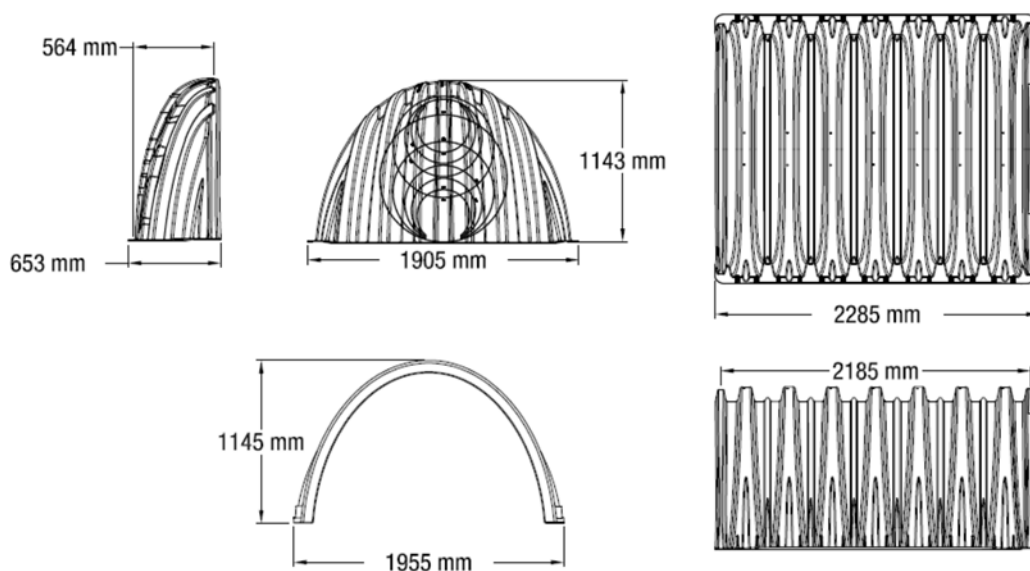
Dimensions de la chambre STORMTECH MC3500 (tolérance : 3 %)
